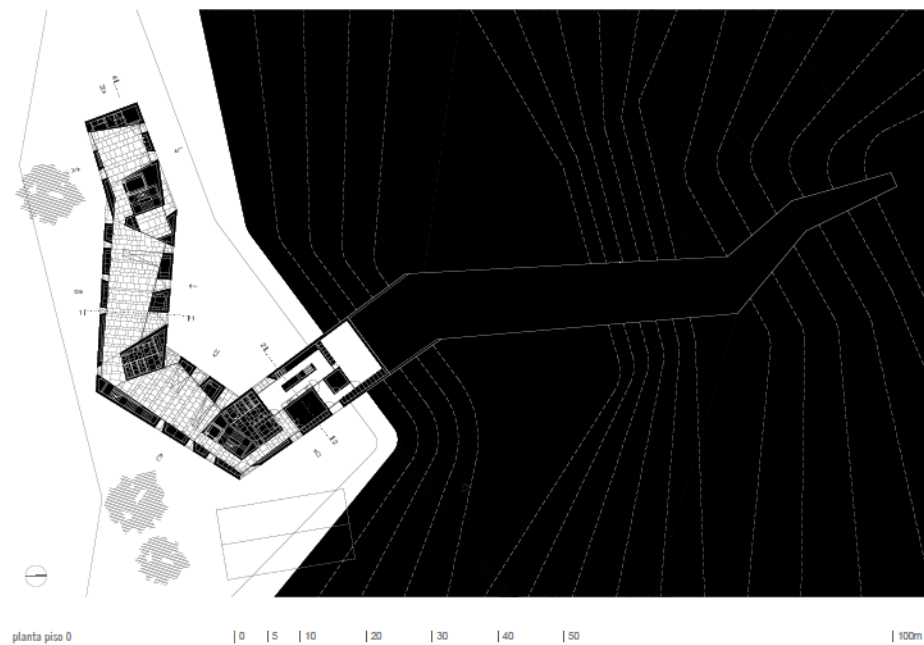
Planta piso 0 do Lar Alcácer do Sal
